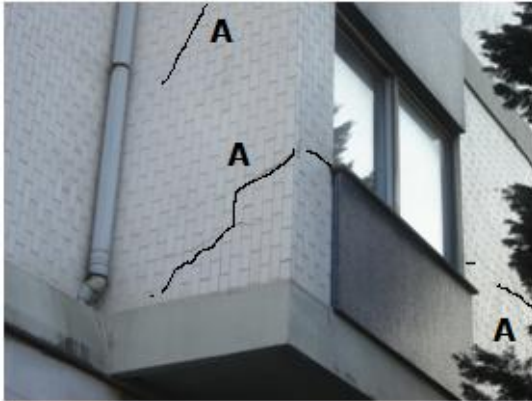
Fissuras/Fendas no avançado “A”
